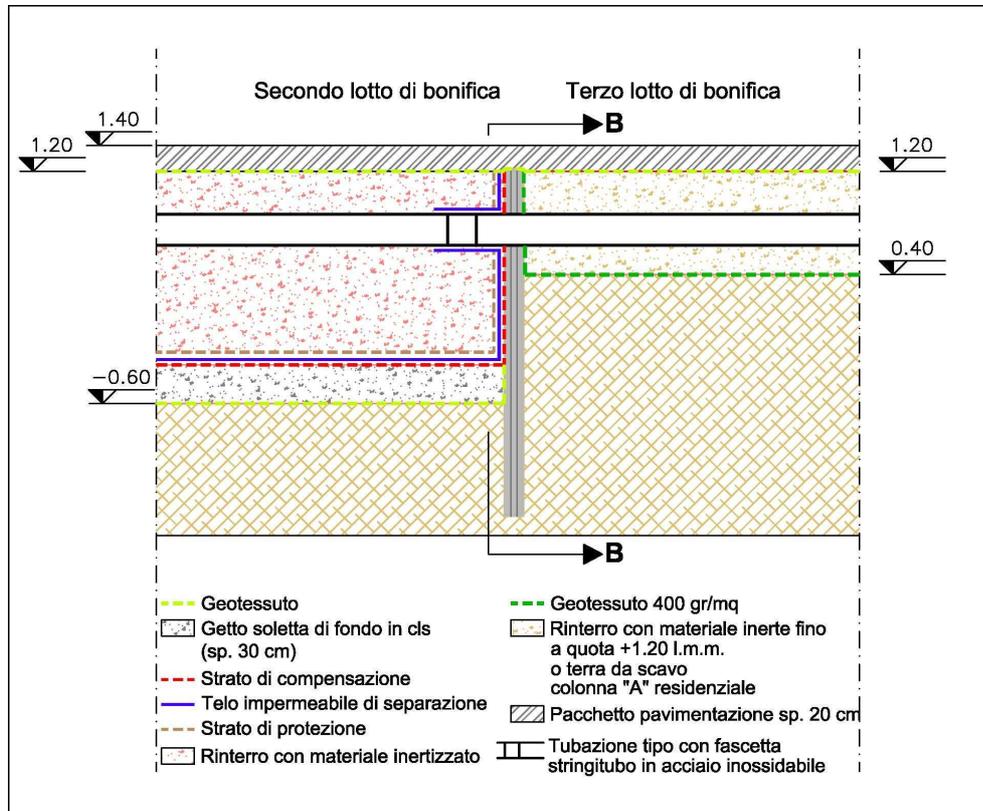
Sezione tipo intersezione tubazione con palancole
